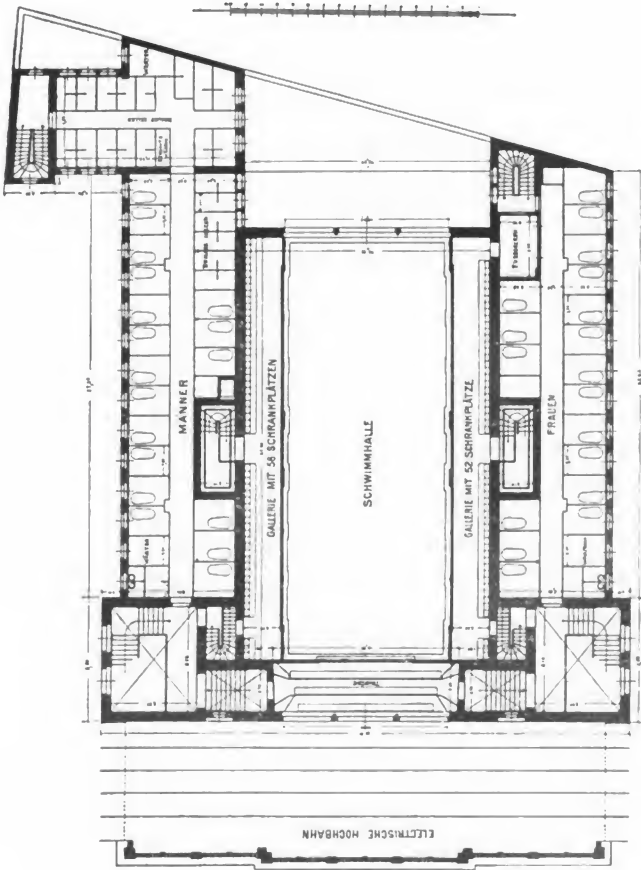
Badeanstalt in Berlin, Dennewitzstraße; Obergeschoß.
